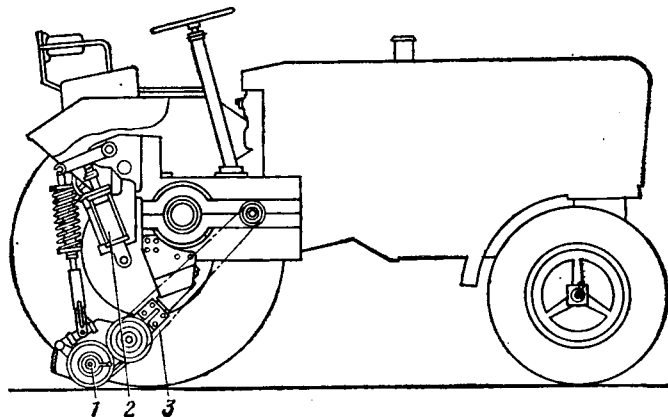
Машина для устройства канавок в покрытие: 1 — рабочий орган (фреза и резцы); 2 — гидромотор; 3 — цепная передача
